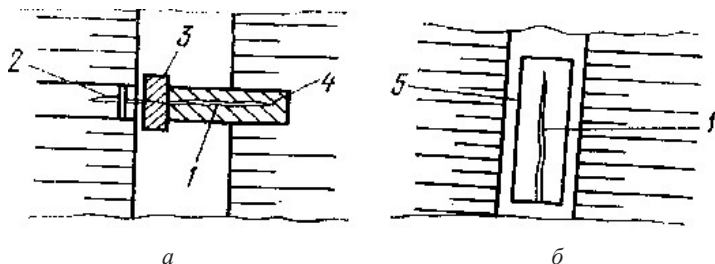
Заделка трещины в земляной дамбе: а – поперечной; б – продольной; 1 – трещина; 2 – шпунт; 3 – замок; 4 – траншея; 5 – контур траншеи
